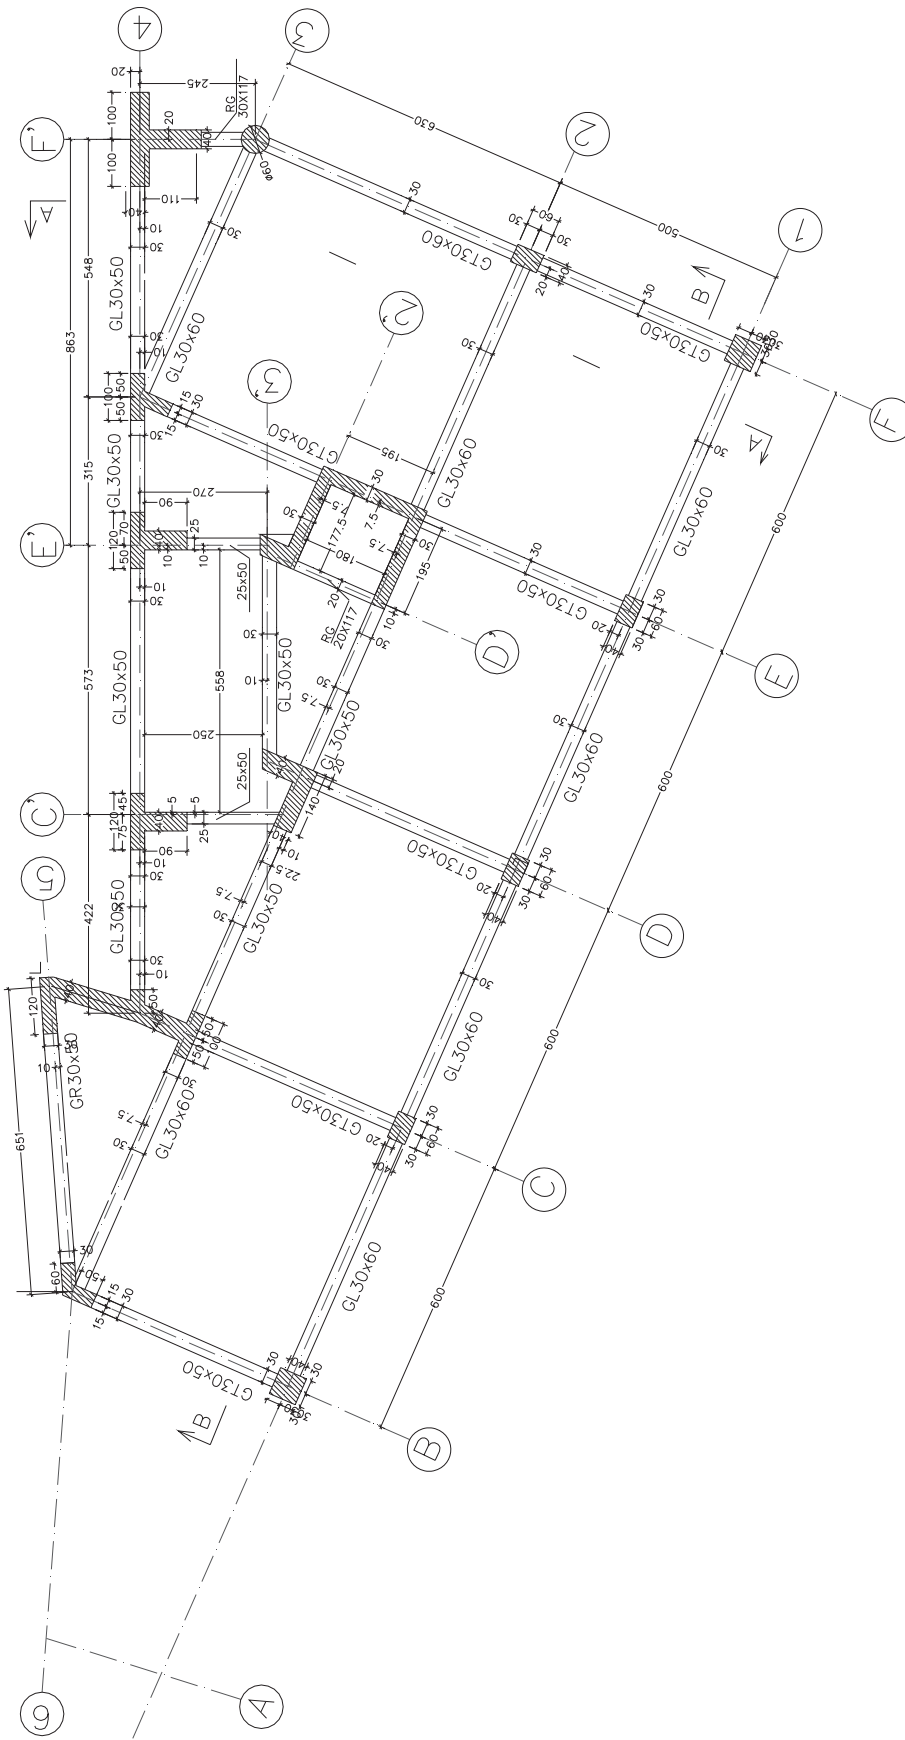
Plan cofraj planșeu la cota +22,07 m
